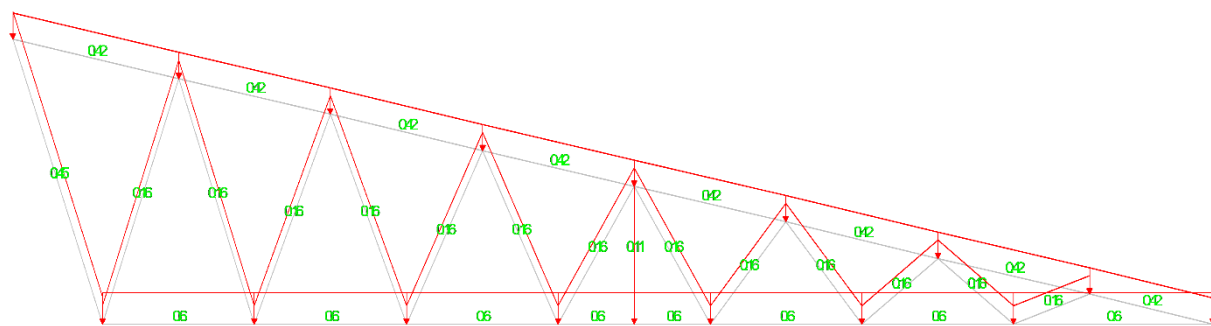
Схема приложения нагрузки собственного веса фермы
